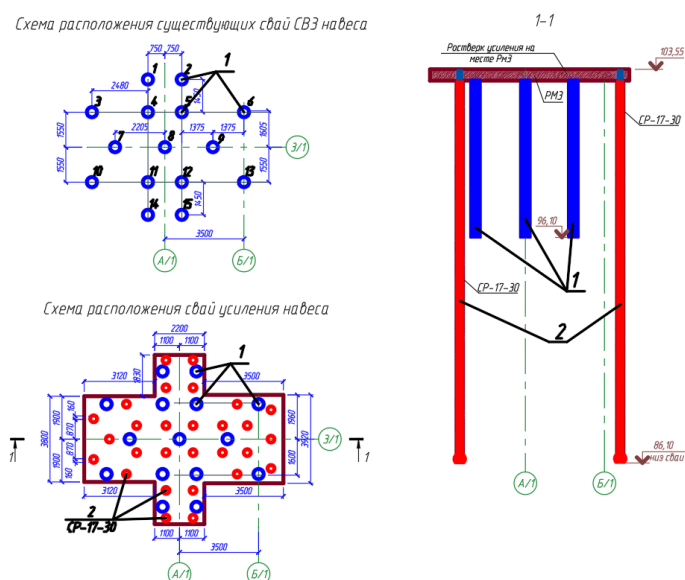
Схема усиления основания фундаментов навеса 1 – существующие забивные сваи; 2 – буринъекционные сваи ЭРТ.
